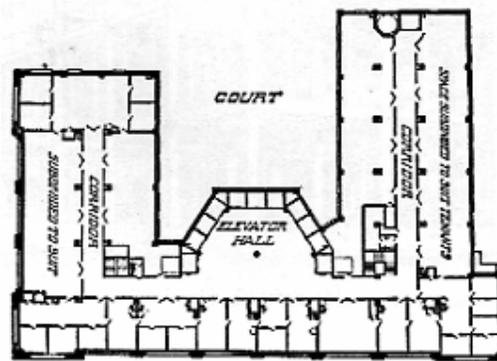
Edifício Marquette, Chicago: planta de um pavimento.
